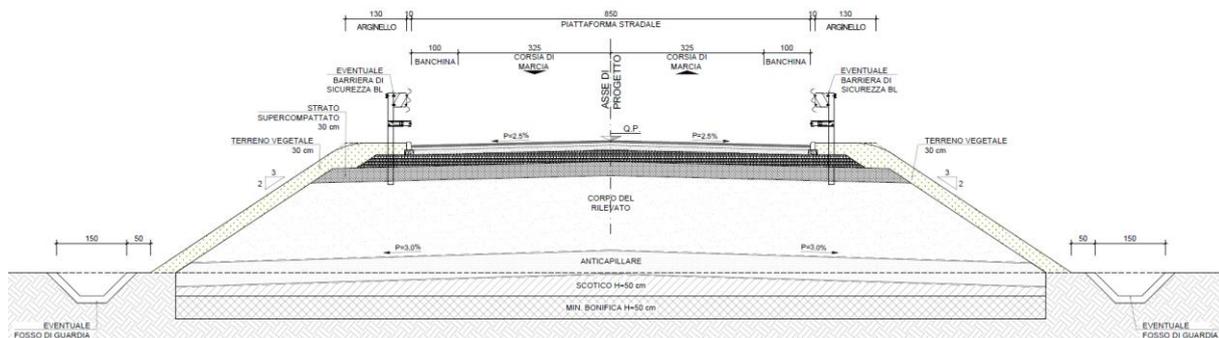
Sezione tipo in rilevato Strada F2 - Locale extraurbana
